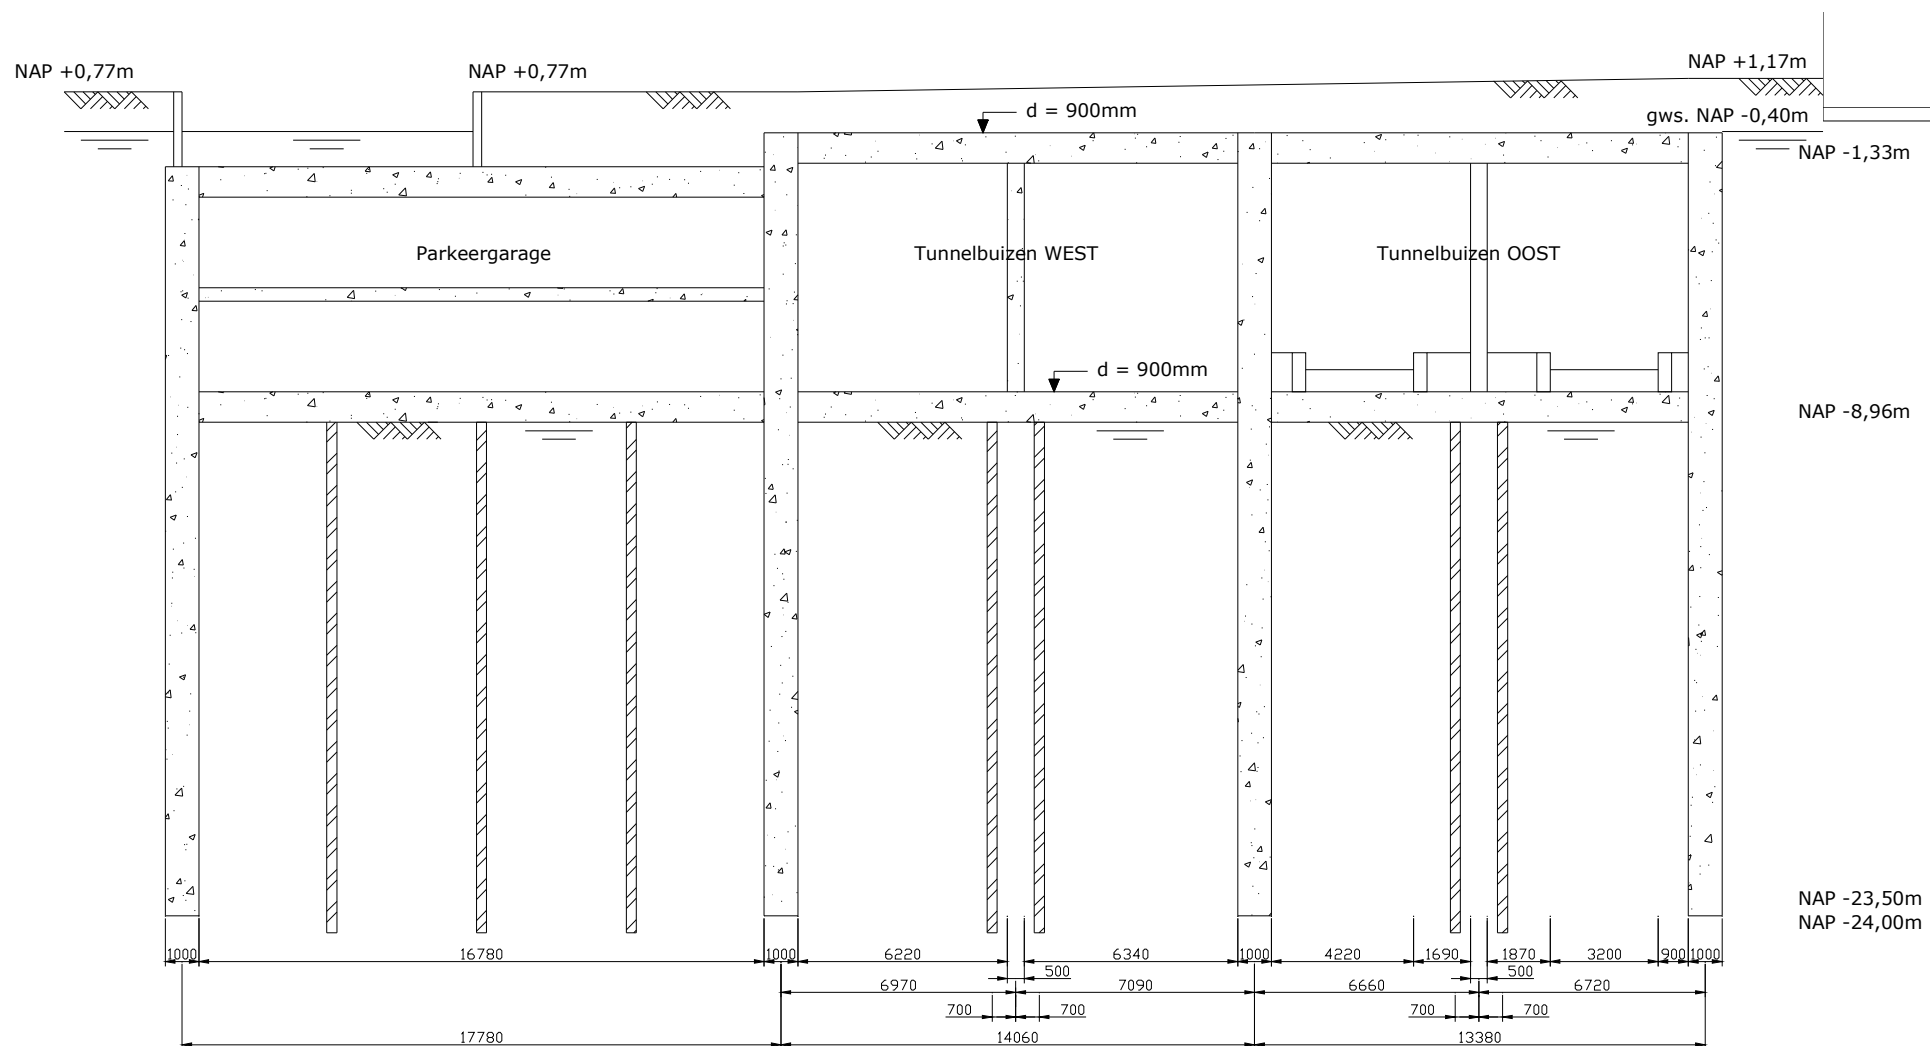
Geometrie parkeergarage en tunnelbuizen tpv. Phoenixstraat 30
